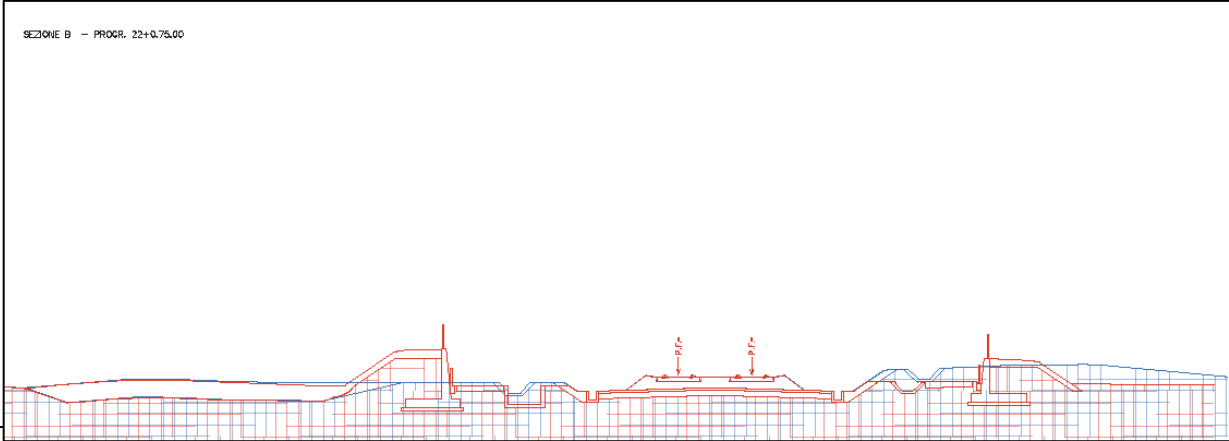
Confronto sezione tracciato PD (in blu) - variante (in rosso, tratto muro di protezione)
